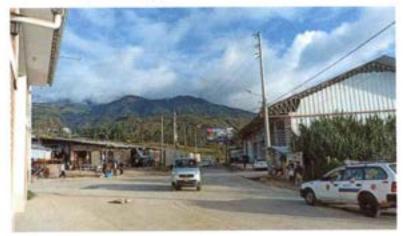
VISTA JR. DOS DE MAYO INTERSECCIÓN CON CARRETERA CHACHAPOYAS-CHICLAYO
